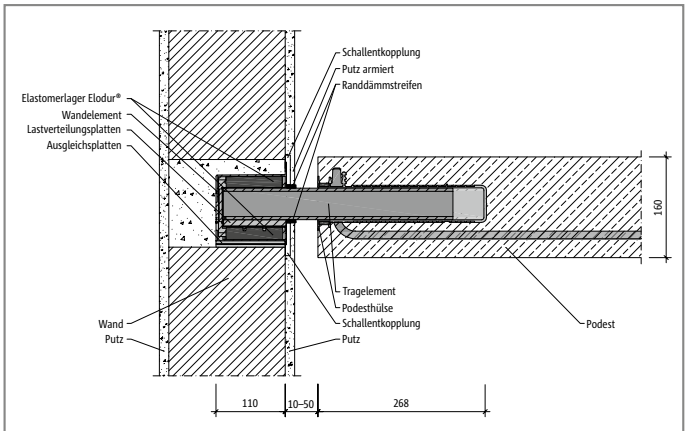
Schöck Tronsole® Typ P: Einbauschritt mit Ortbetonpodest und Luftfuge
